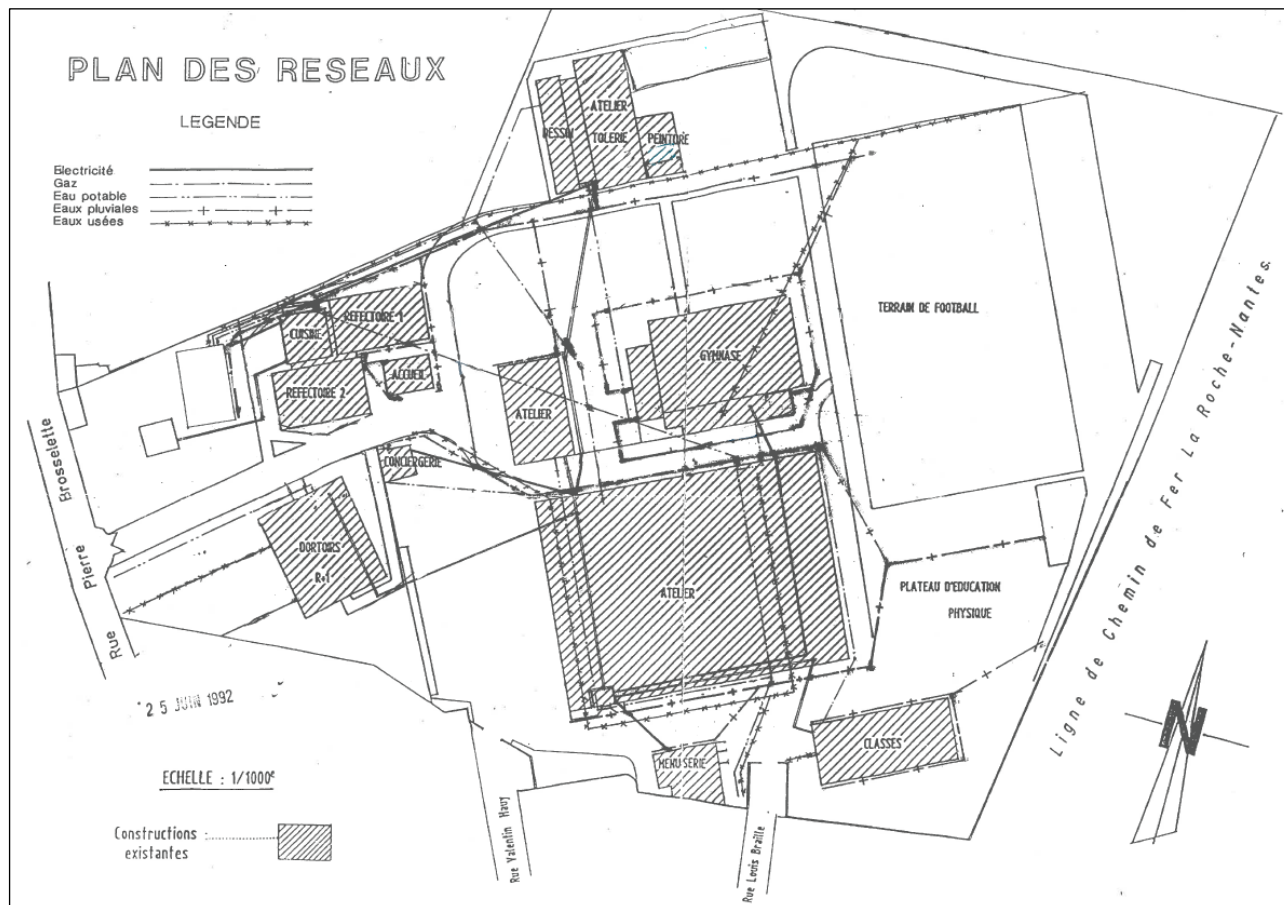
PLAN DES BATIMENTS DU SITE (SOURCE : CLIENT)
